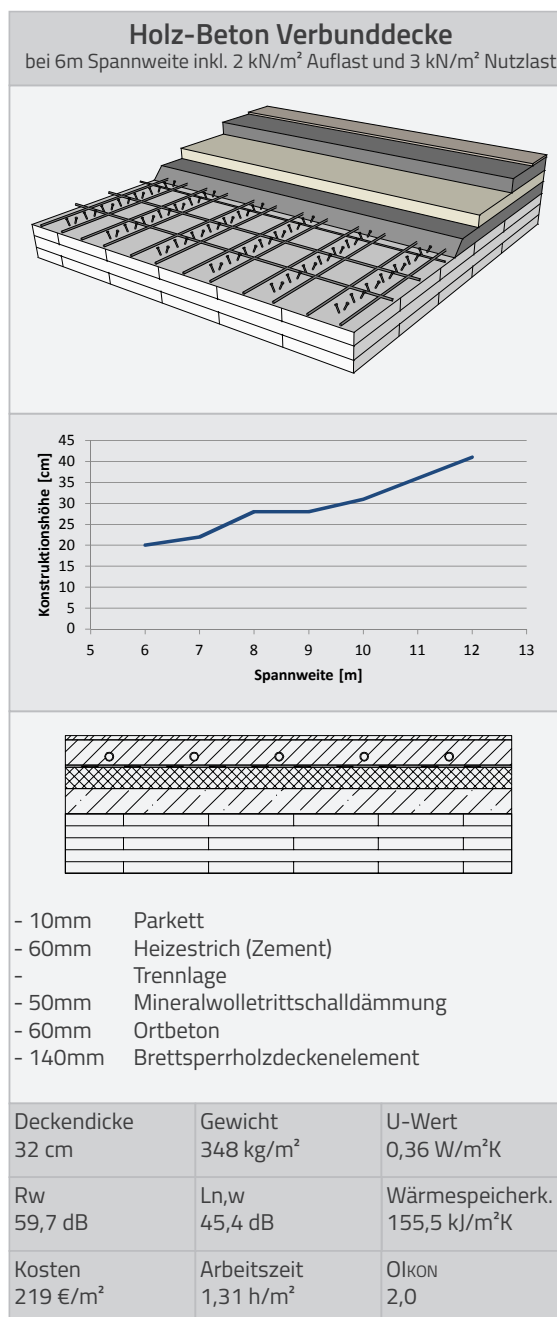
Kompaktübersicht Holz-Beton Verbunddecke
